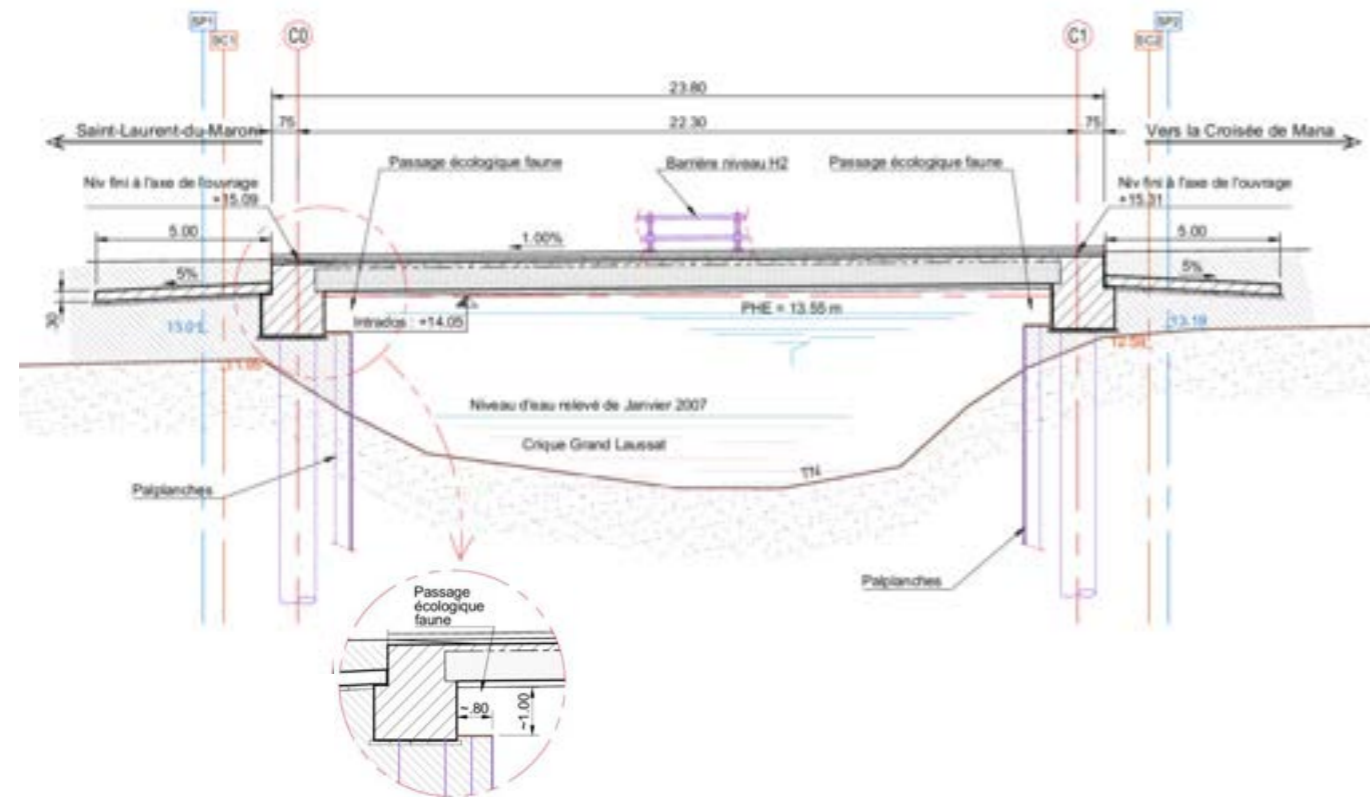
Coupe longitudinale de l'ouvrage projeté
